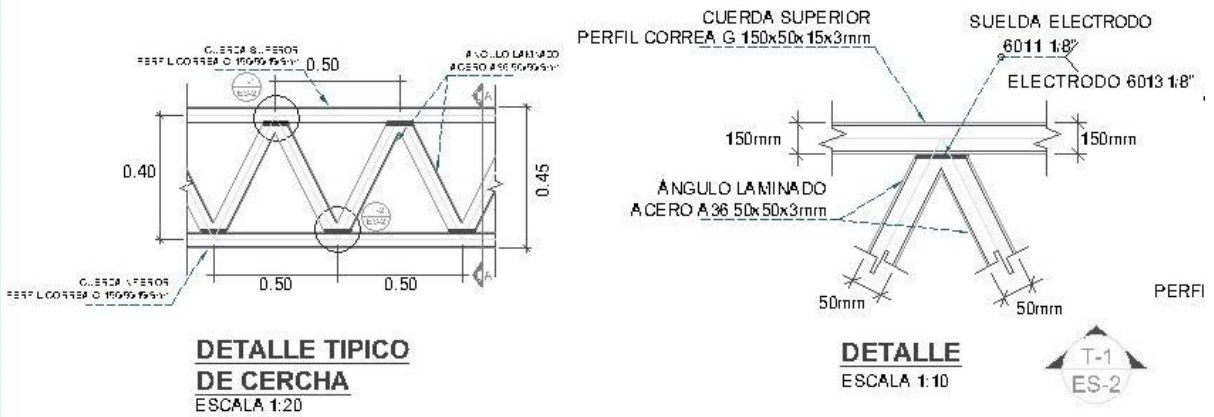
Detalle constructivo cercha. Elaboración Propia.
